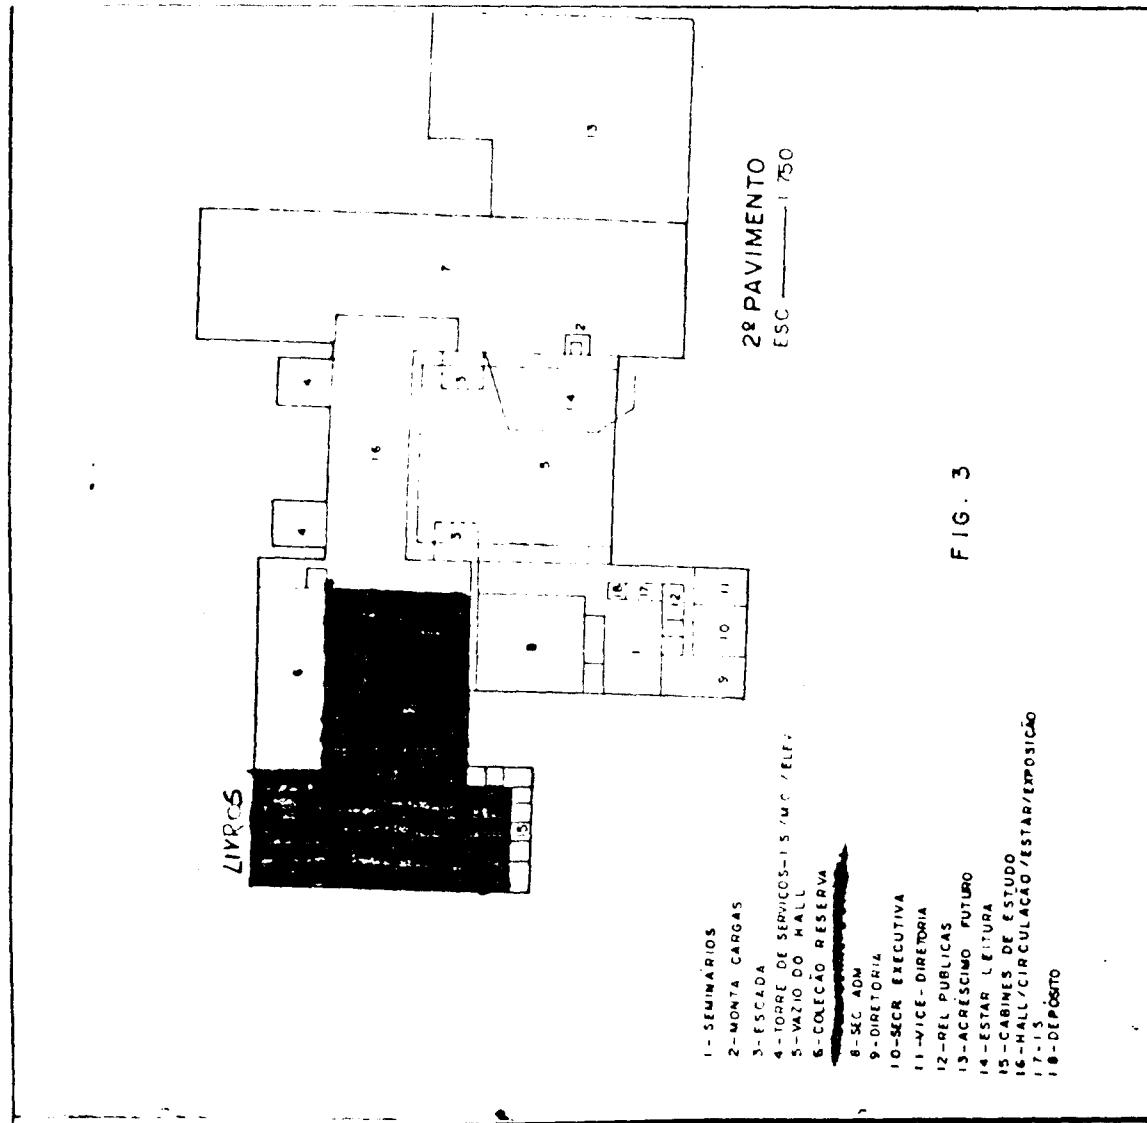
Projeto de construção do prédio da Biblioteca central - 2º pavimento
